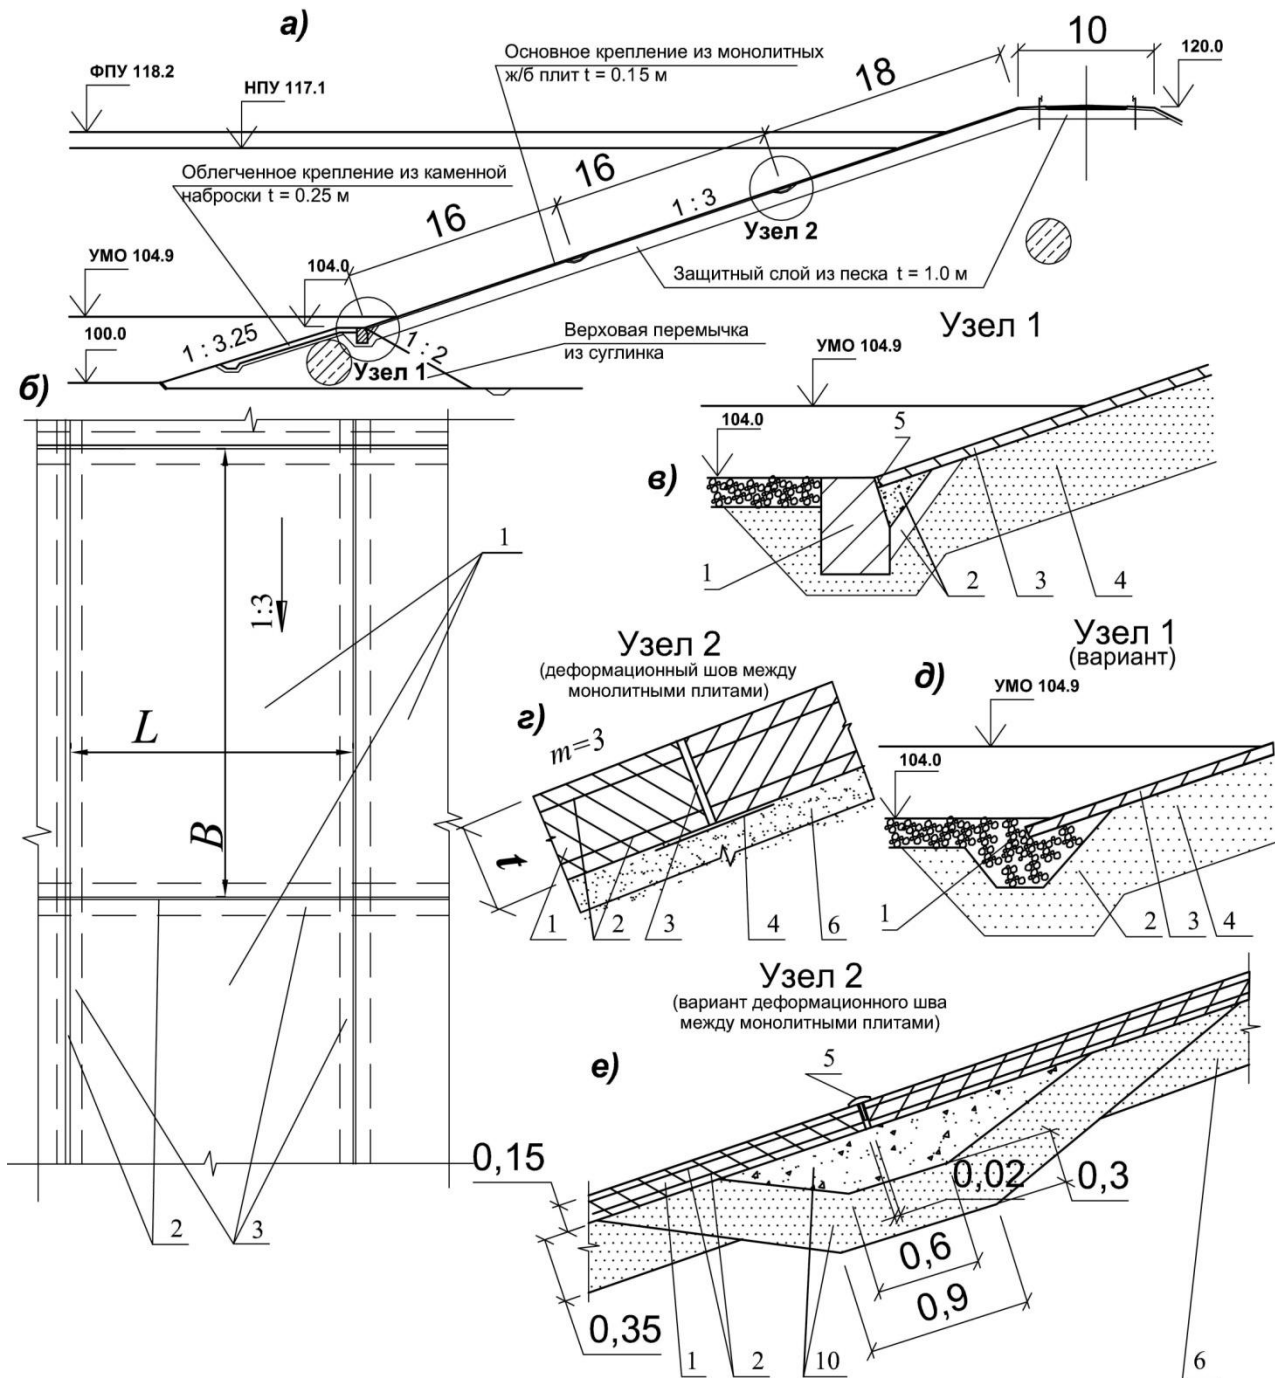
Укрепление откоса из монолитных железобетонных плит [8]:
